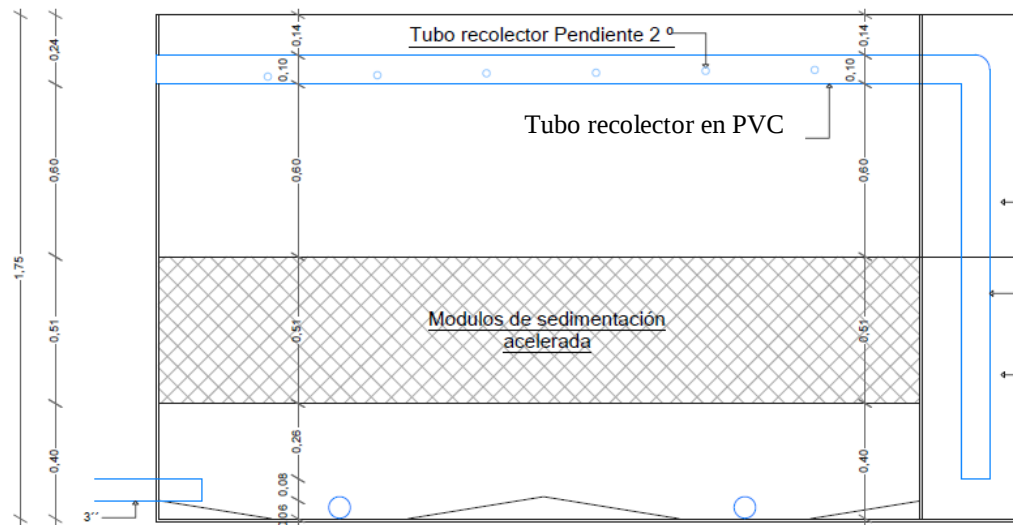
Vista de perfil longitudinal del sedimentador propuesto para el tratamiento
